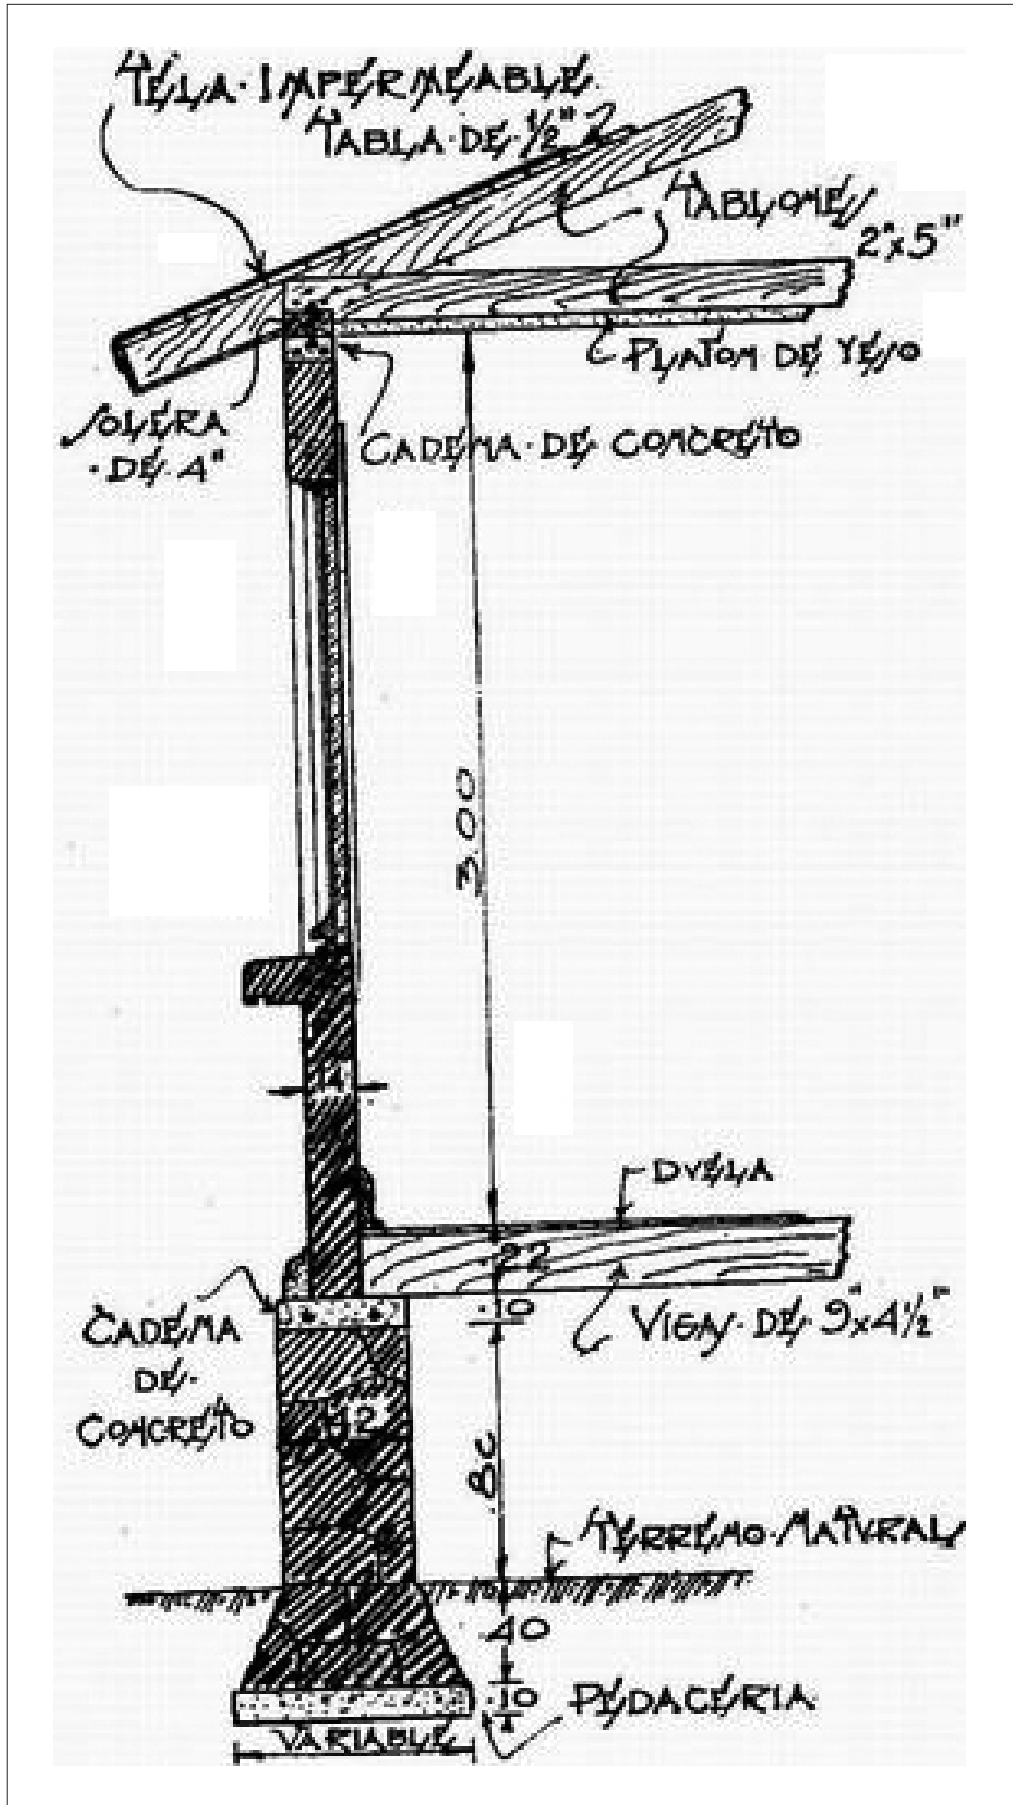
; detalle constructivo de la casa ubicada en Calzada de Tacubaya 134, el sistema constructivo es híbrido pues emplea los sistemas convencionales de producción artesanal en combinación con sistemas constructivos de producción industrial como el concreto.
